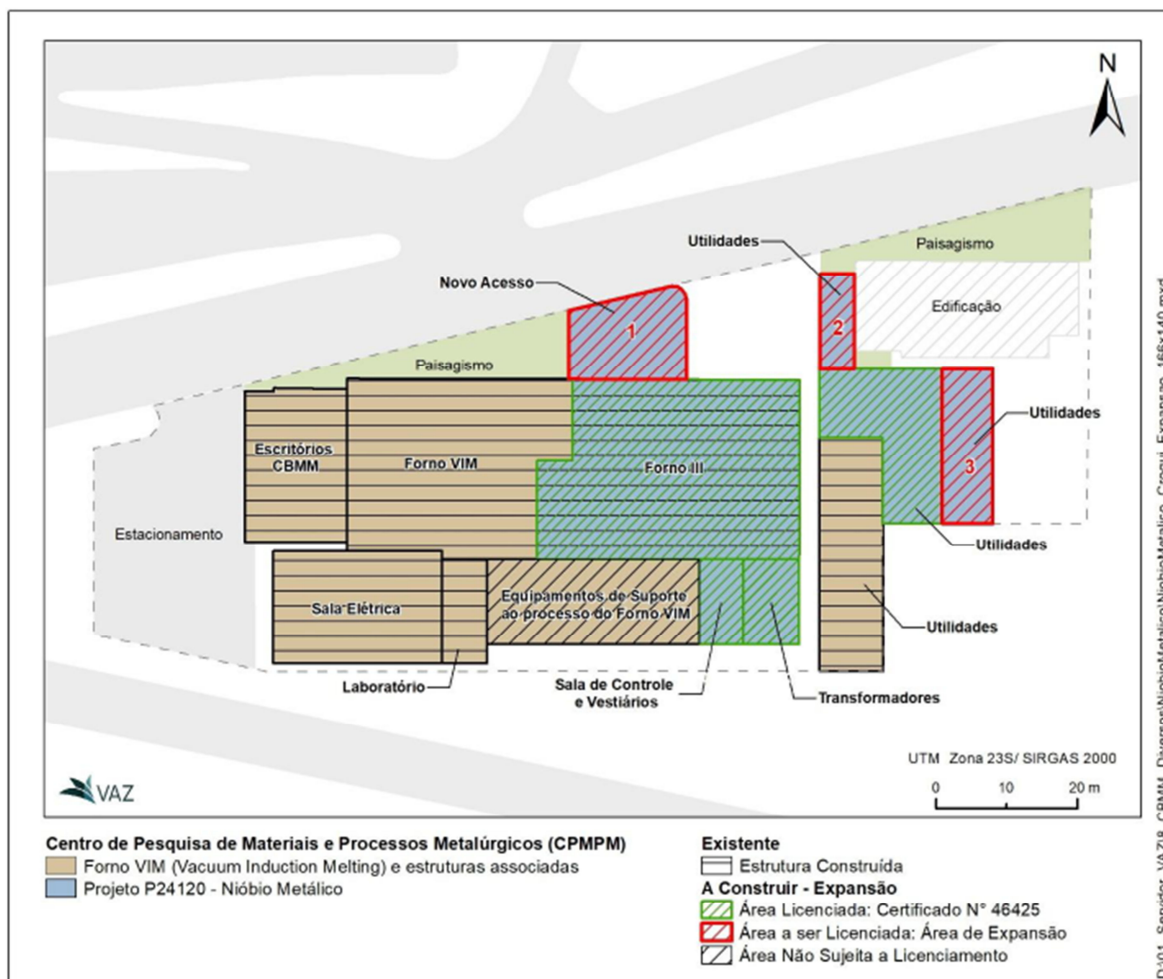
Planta de localização do projeto do novo forno e infraestruturas de apoio. Fonte RCA CBMM (2026).
